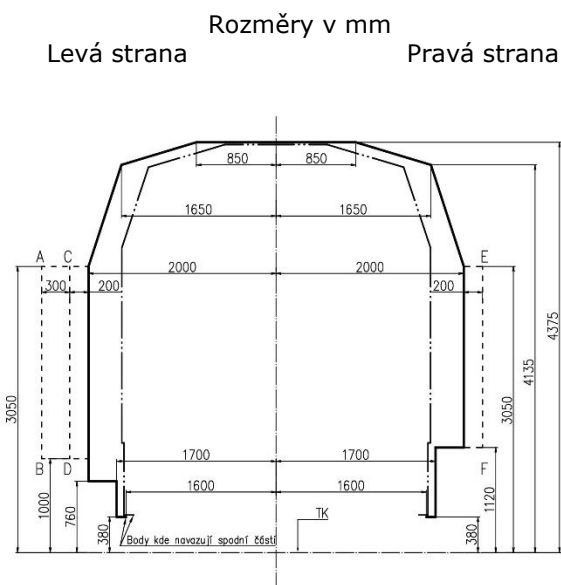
Průjezdový průřez Z-GC
